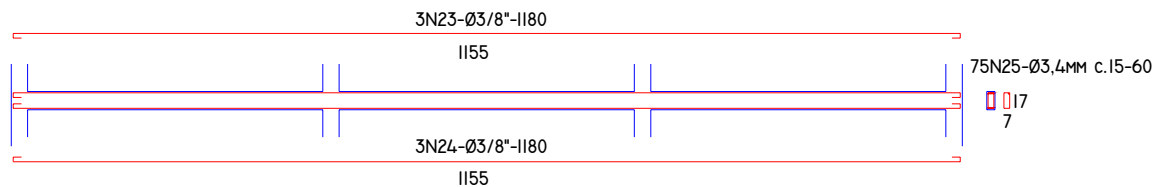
Planta de armação das vigas à nível de piso da creche (suinocultura).
